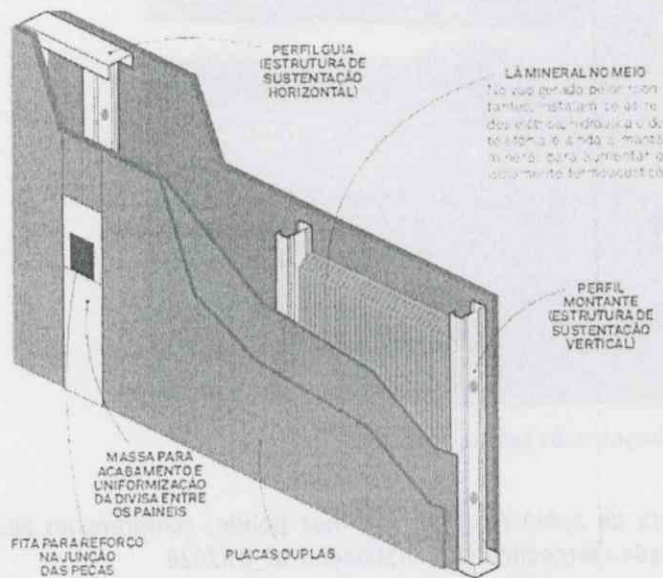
A imagem ilustra esquema de instalação de parede de drywall.
